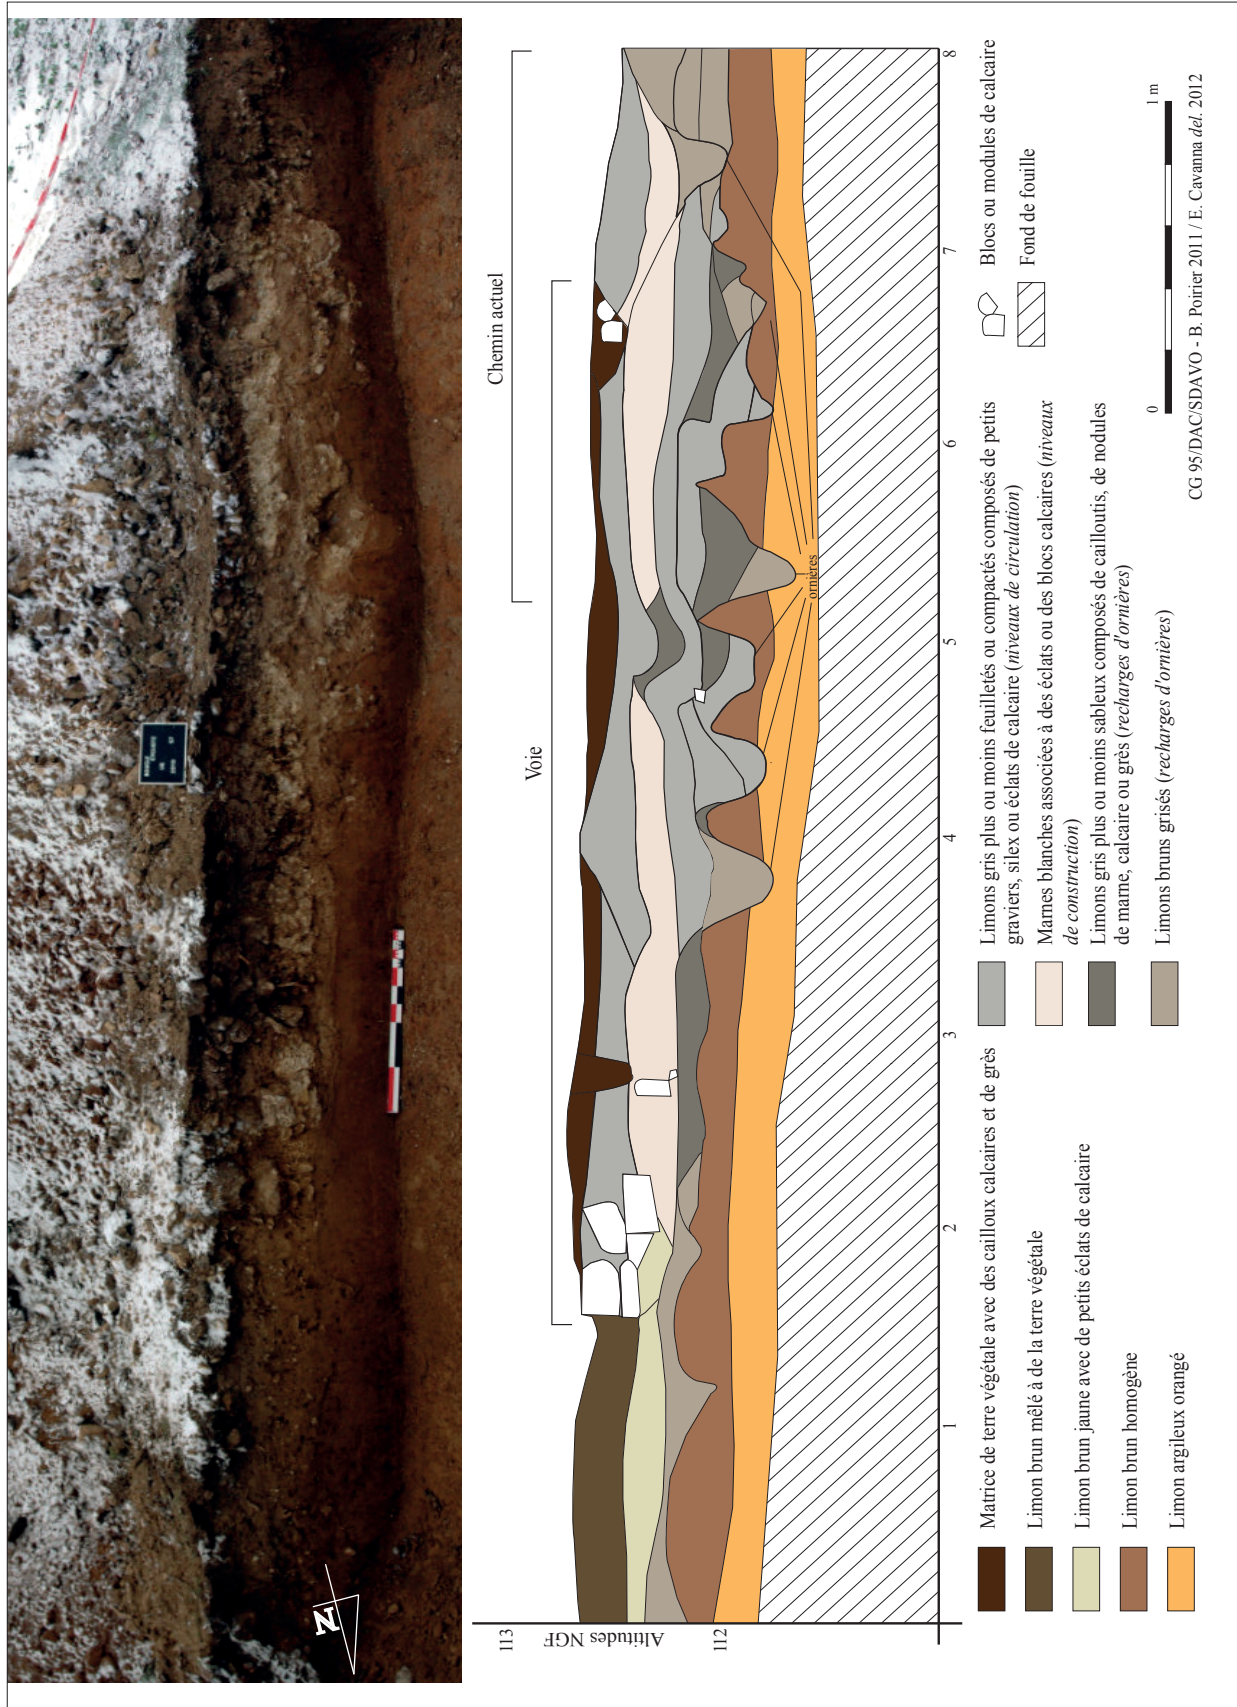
Coupe de la voie dans le sondage 7 (B. Poirier CG95-DAC-SDAVO-2010, planche E. Cavanna del.).
